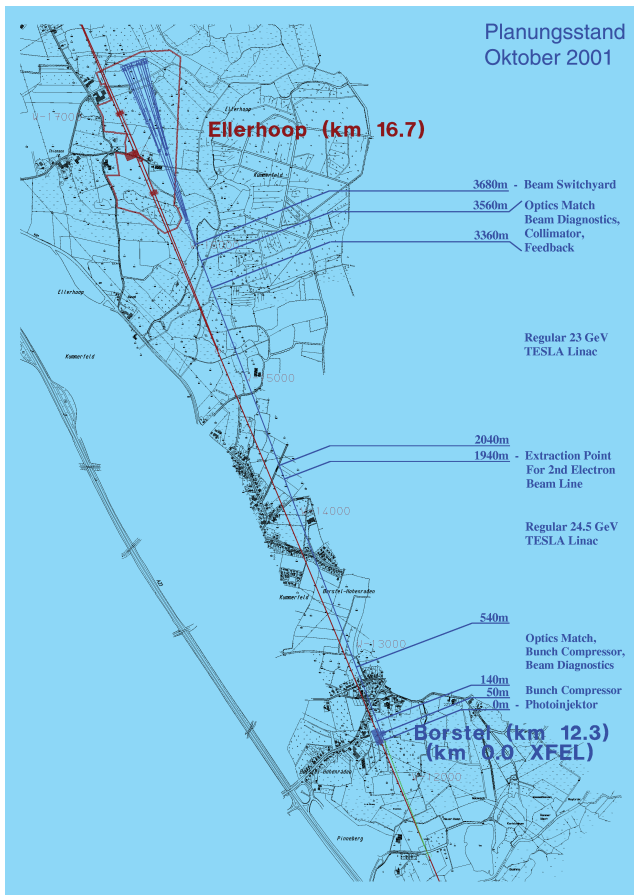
Ausschnitt aus dem TESLA-Lageplan mit einem getrennten XFEL Beschleunigertunnel.
